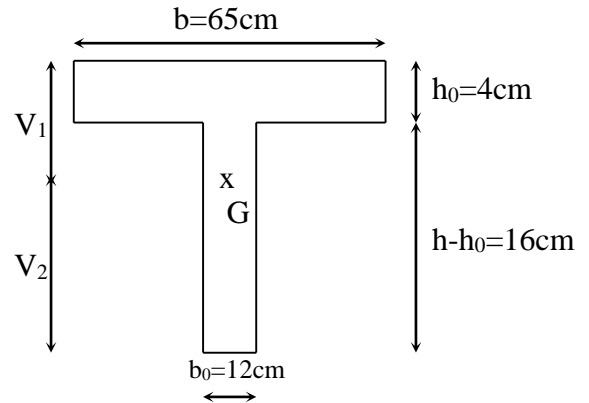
schéma représentatif du centre de gravité de la poutrelle
